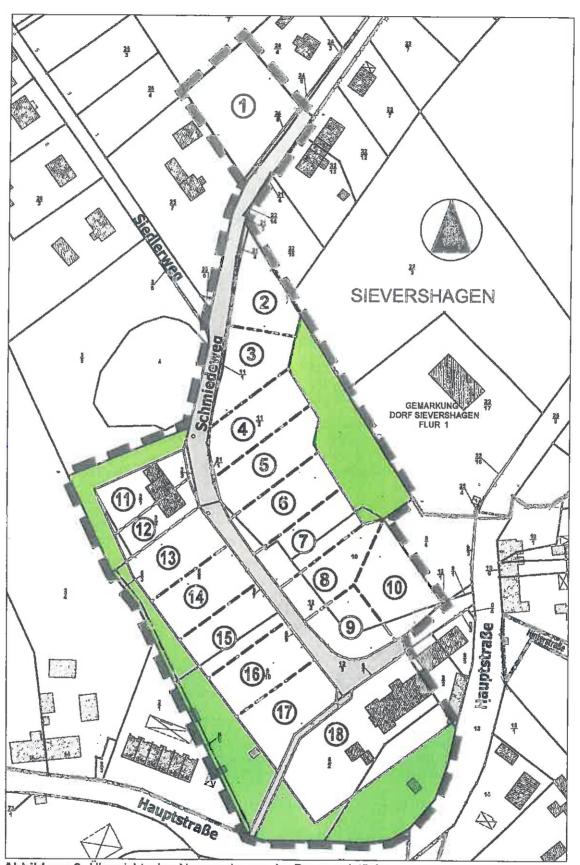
Übersichtsplan Nummerierung der Baugrundstücke
